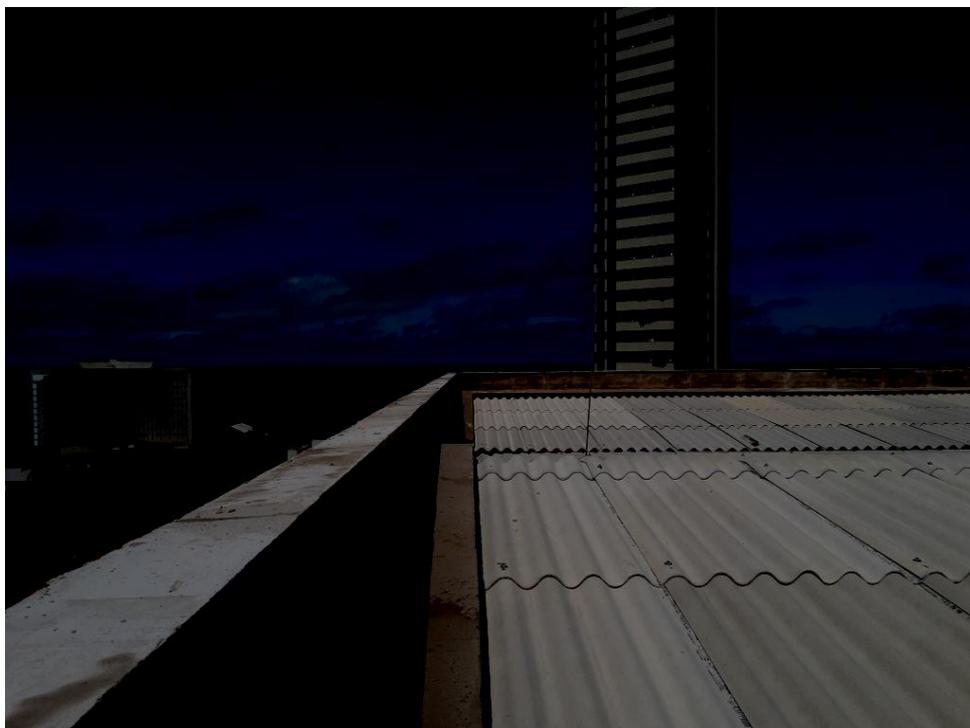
Vista geral da laje de cobertura. Platibanda, calha de drenagem e madeiramento da cobertura executados e telhas instaladas.
